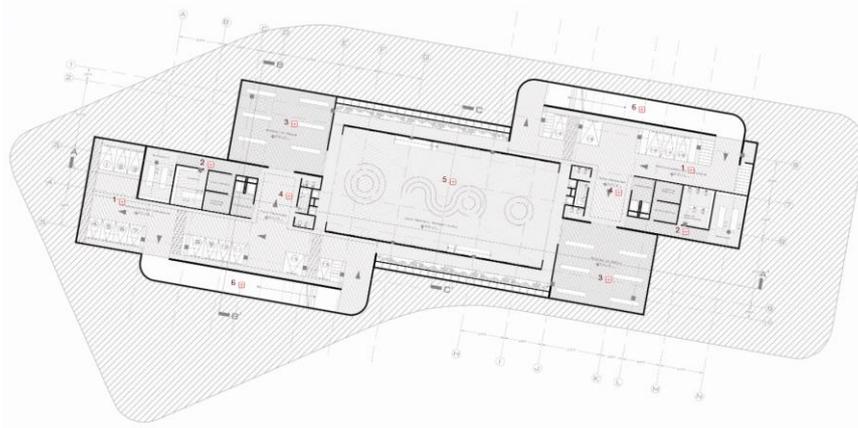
Planta Subsuelo 1 (Elaboración propia)
